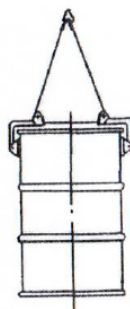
Застропка металлической бочки захватами типа КЗРЦ
